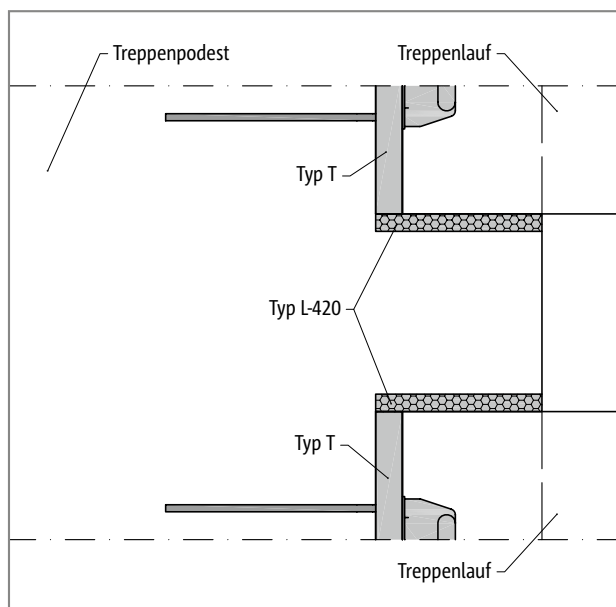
Schöck Tronsole® Typ T: Elementanordnung Detail A
